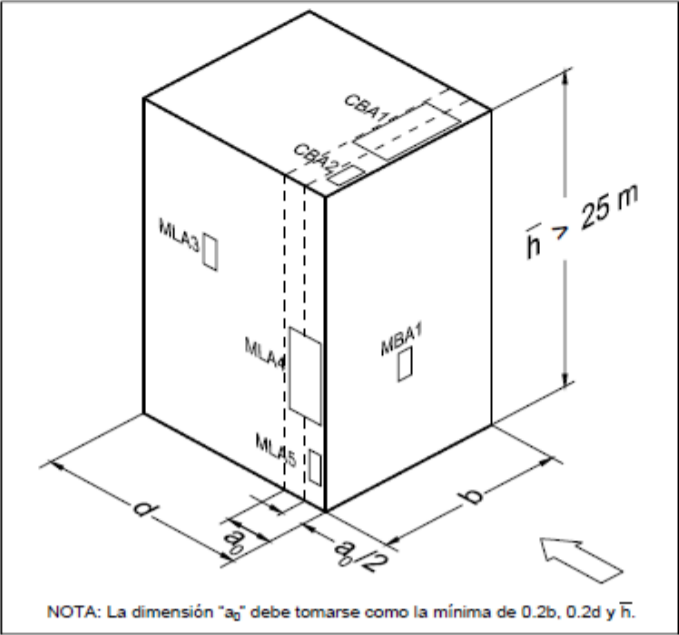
(e) zonas para la determinación de los factores de presión local, K_L , para recubrimientos y sus soportes construcciones con techo plano y alturas mayores que 25 m
